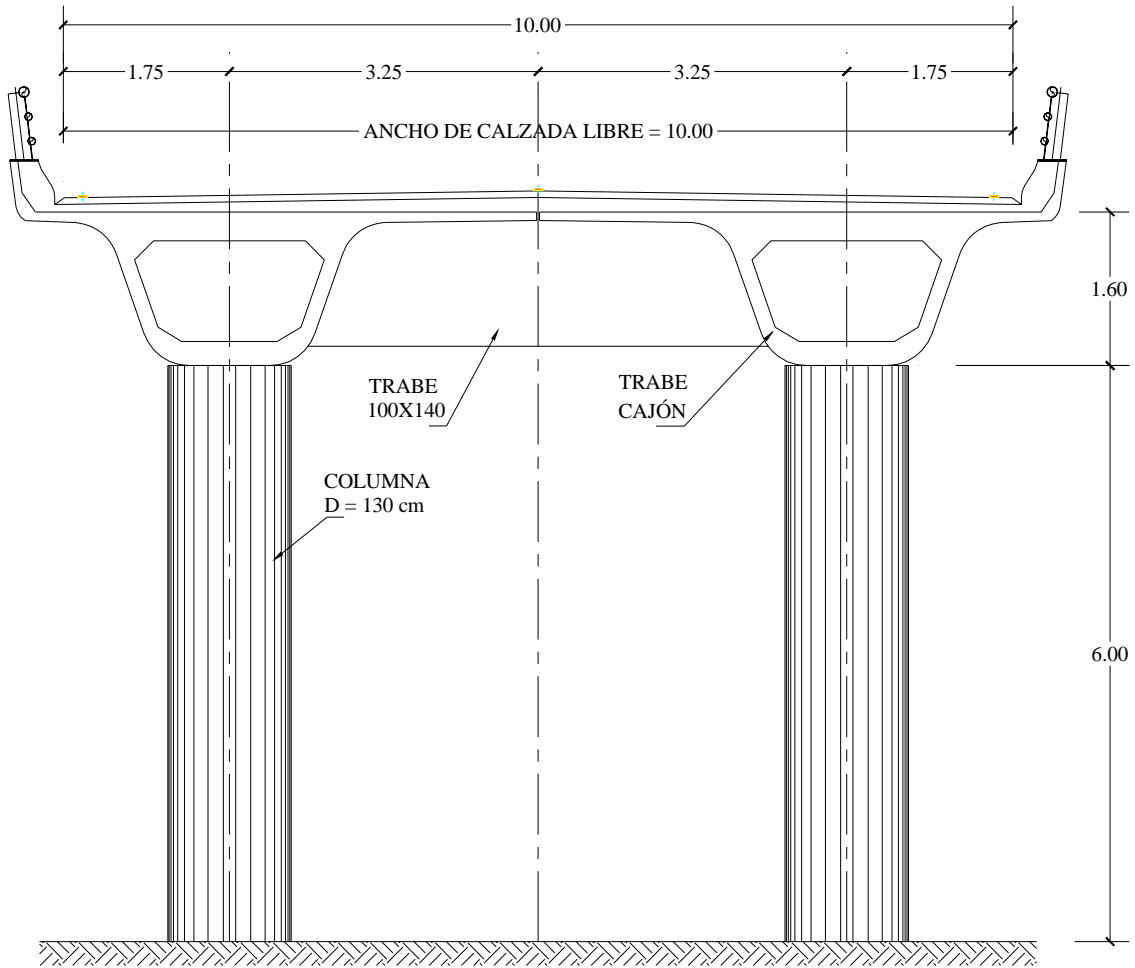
Sección transversal con 4 columnas puente urbano, eje B
